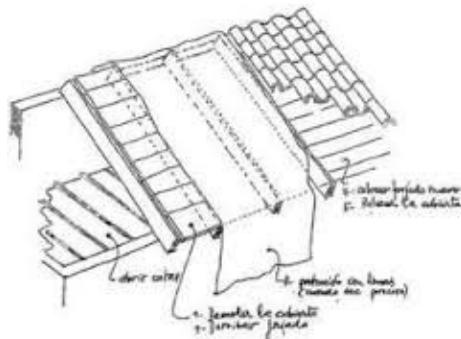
Estructura de cubierta a base de vigas y correas de madera.
